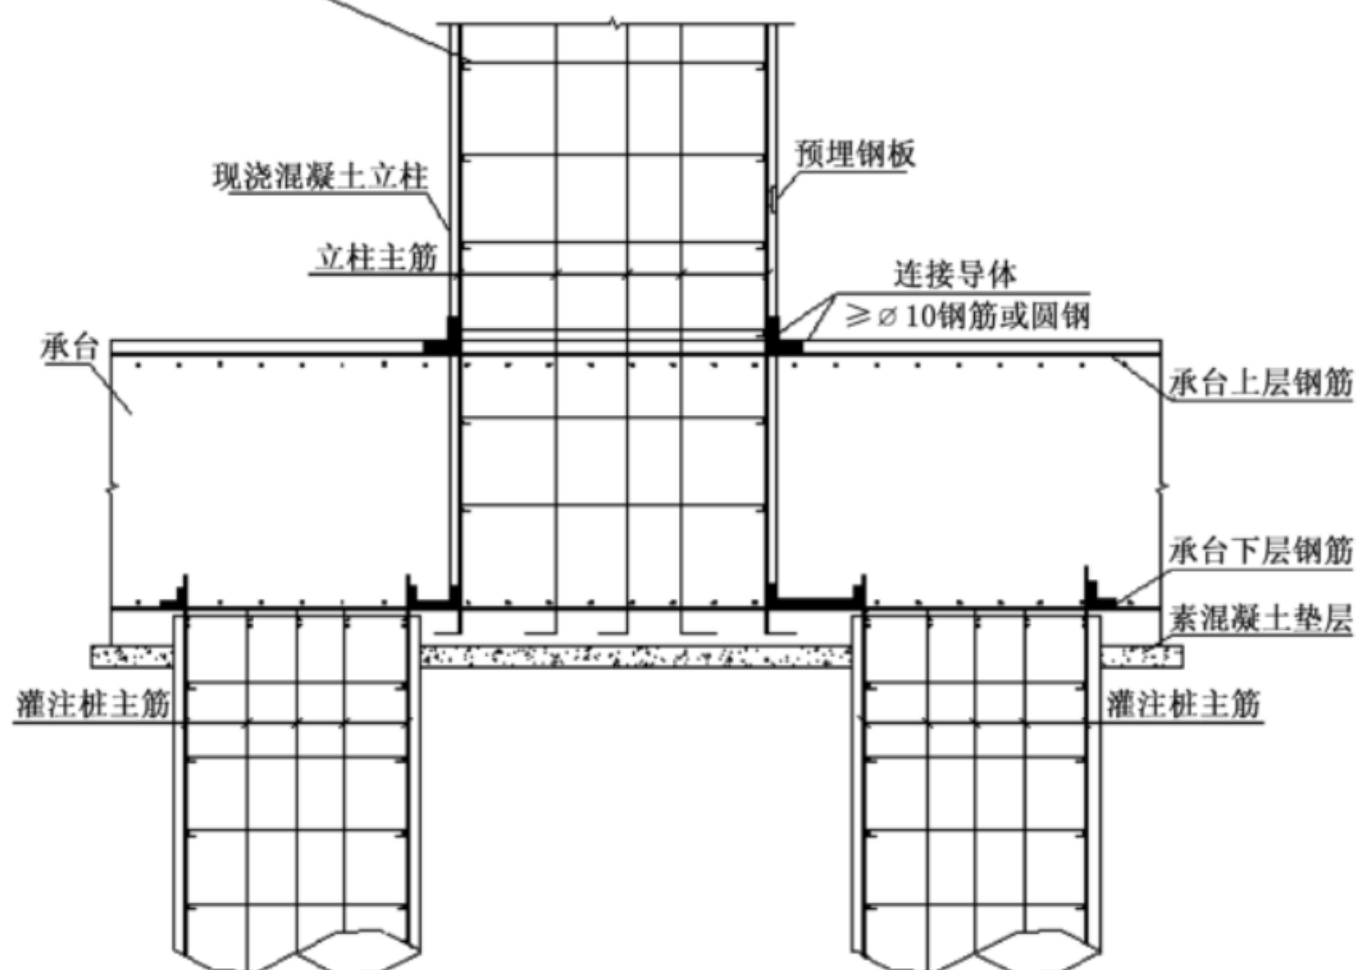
承台与立柱 桩基钢筋焊接施工大样图
